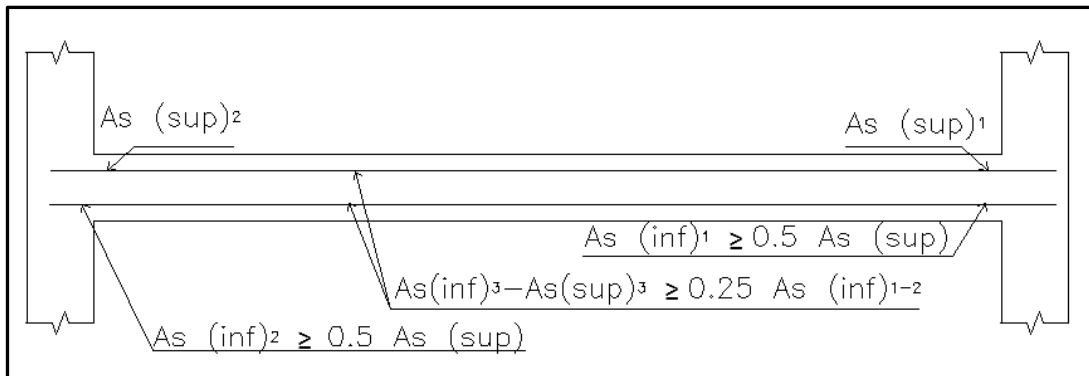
DIMENSIONES DE VIGA ESTABLECIDOS POR LA ACI
